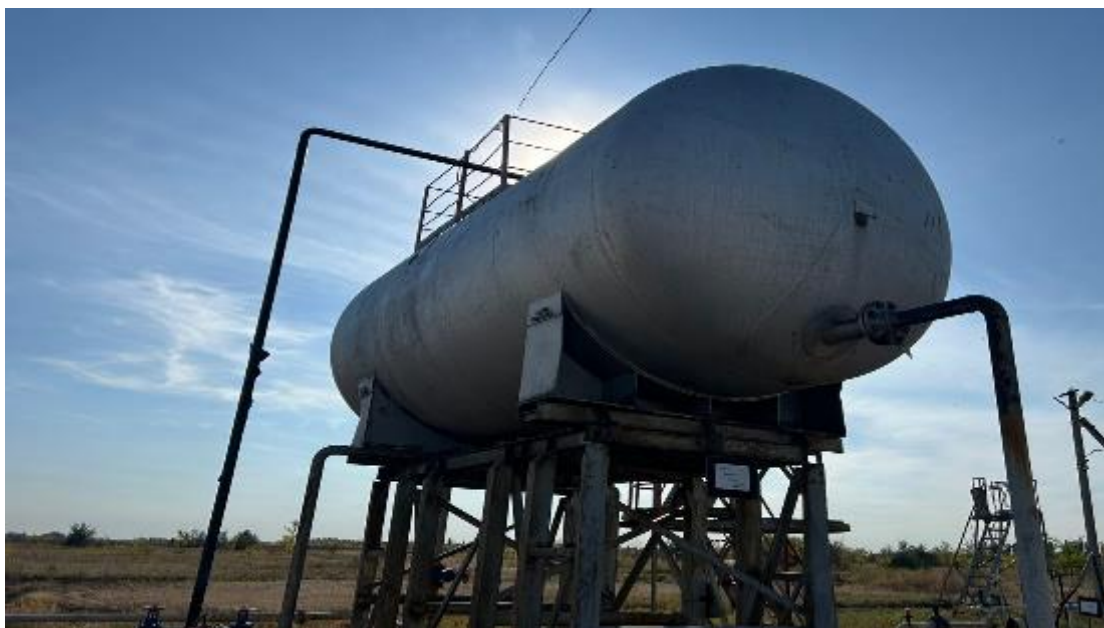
Общий вид резервуара горизонтального стального РГС-50 заводской номер 24497
